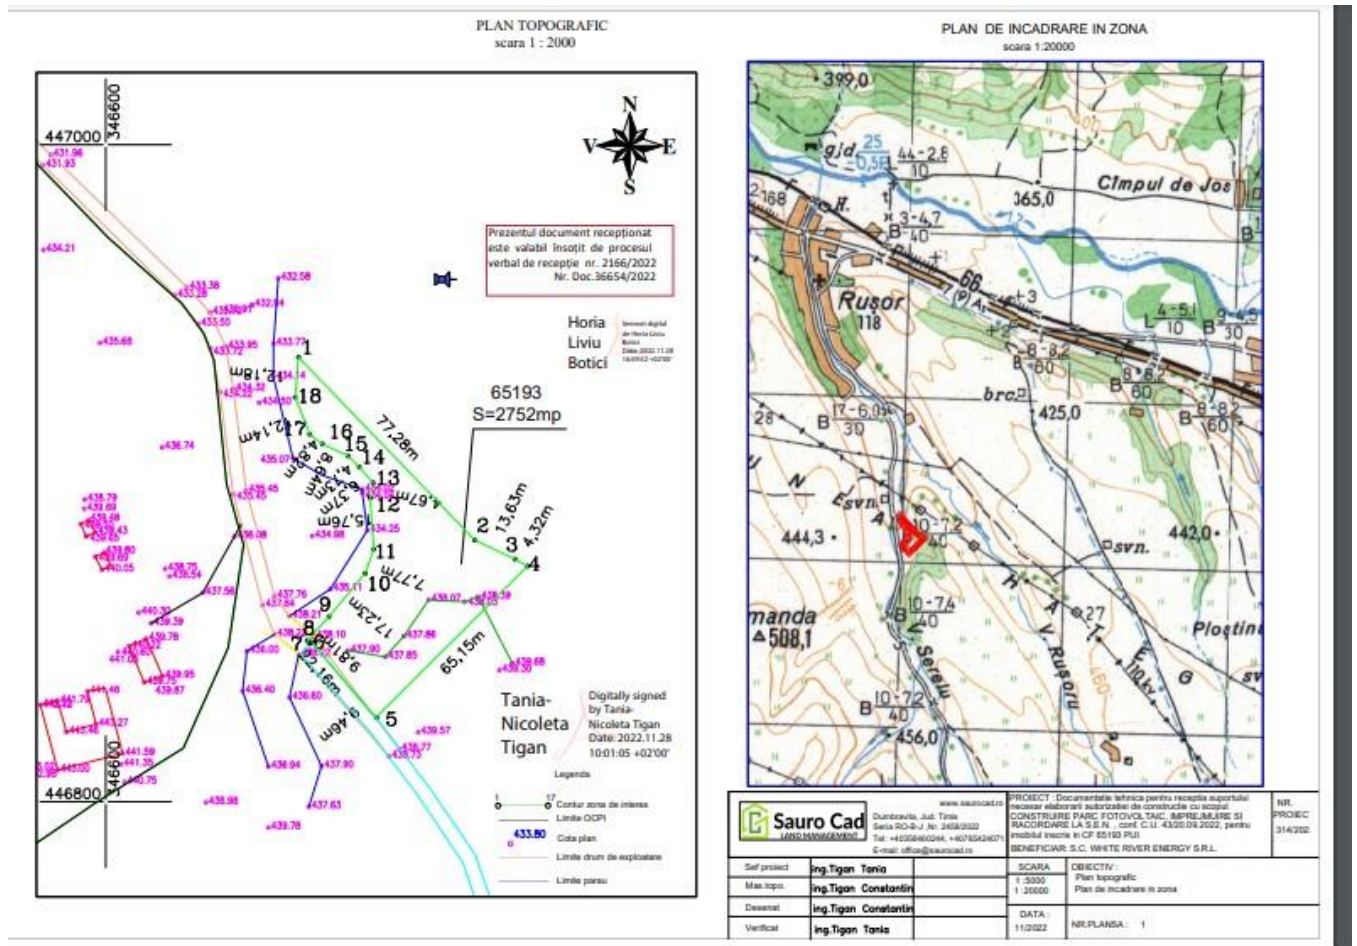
Incadrarea in zona a proiectului si plan de situatie
